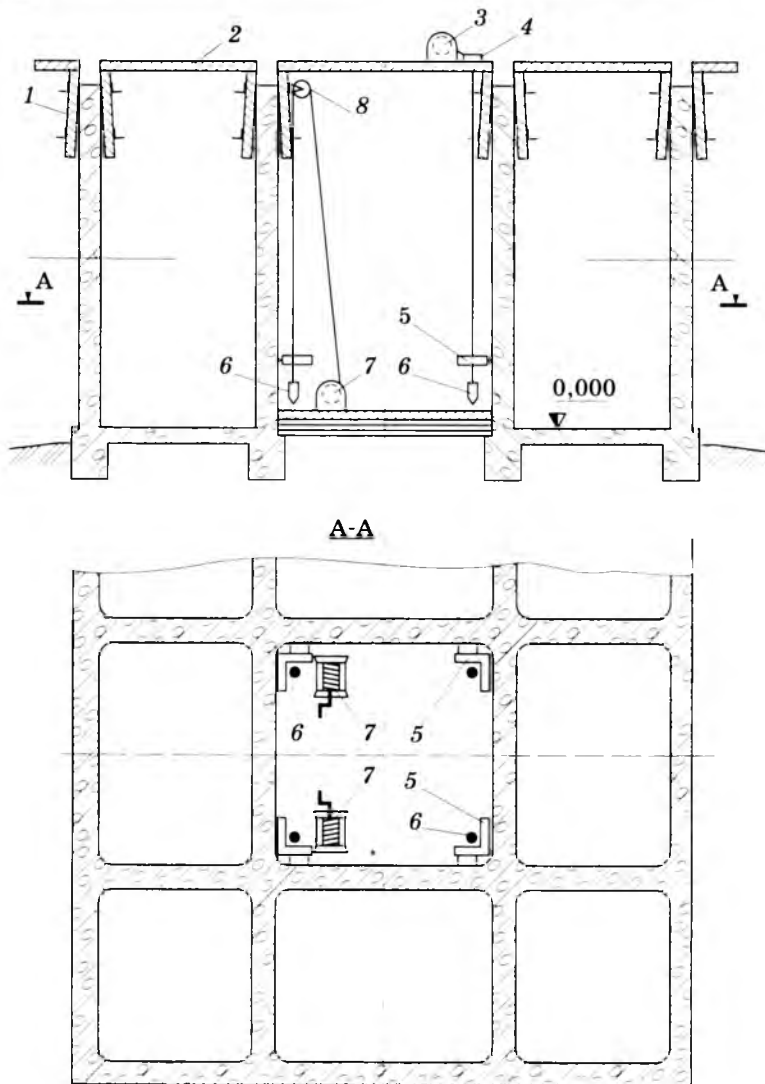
Схема расположения оборудования и отвесов при проверке положения опалубки:
